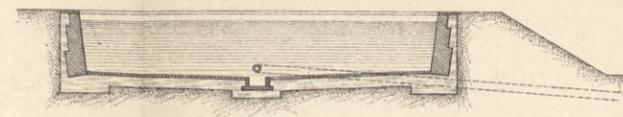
<sup>c</sup> Schnitt durch ein Filter. M.1:400.
